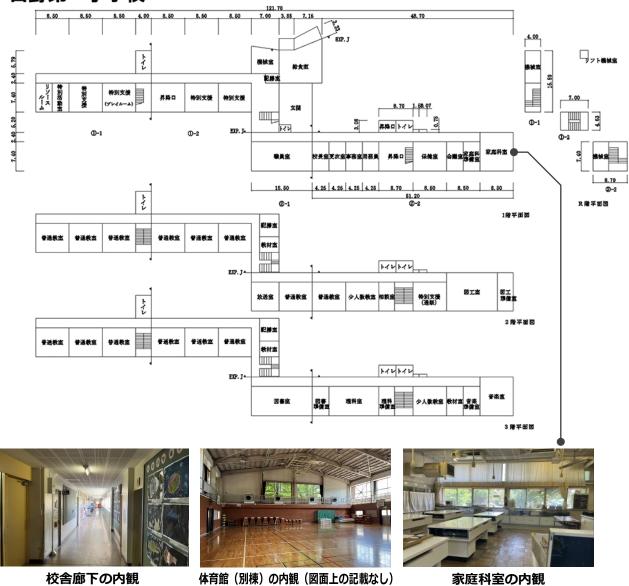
日野第一小学校の平面図及び特徴的な諸室等の内観 (平面図: 日野市資料より引用)
